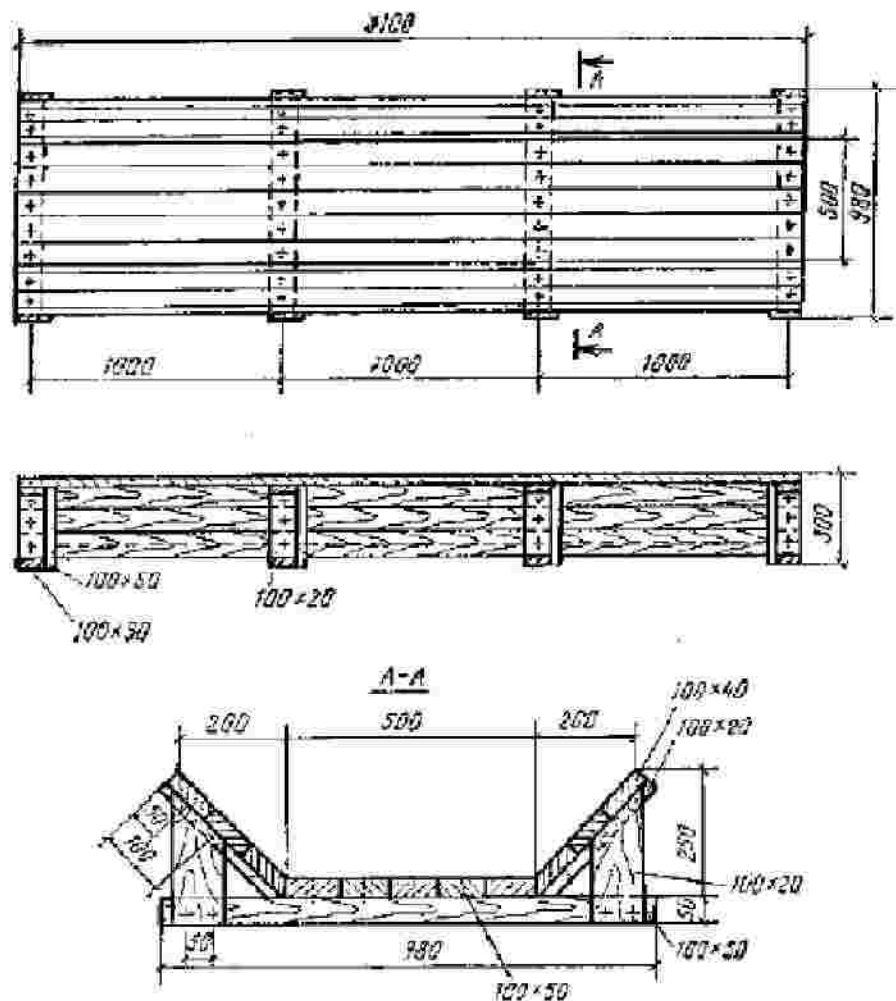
Лоток для укладки кабеля для кранов без кабельного барабана.
